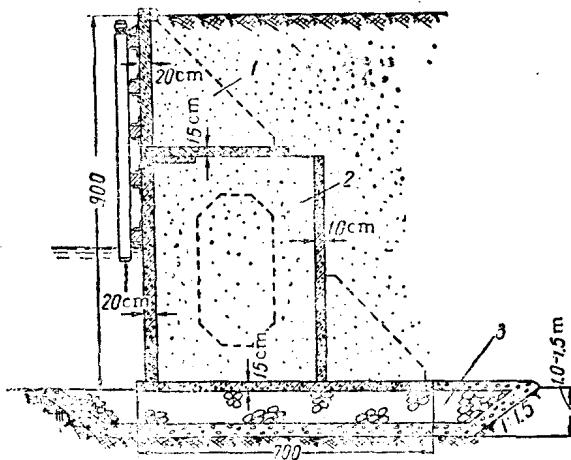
由沉箱及L形钢筋混凝土上部结构组成的岸壁的横断面
